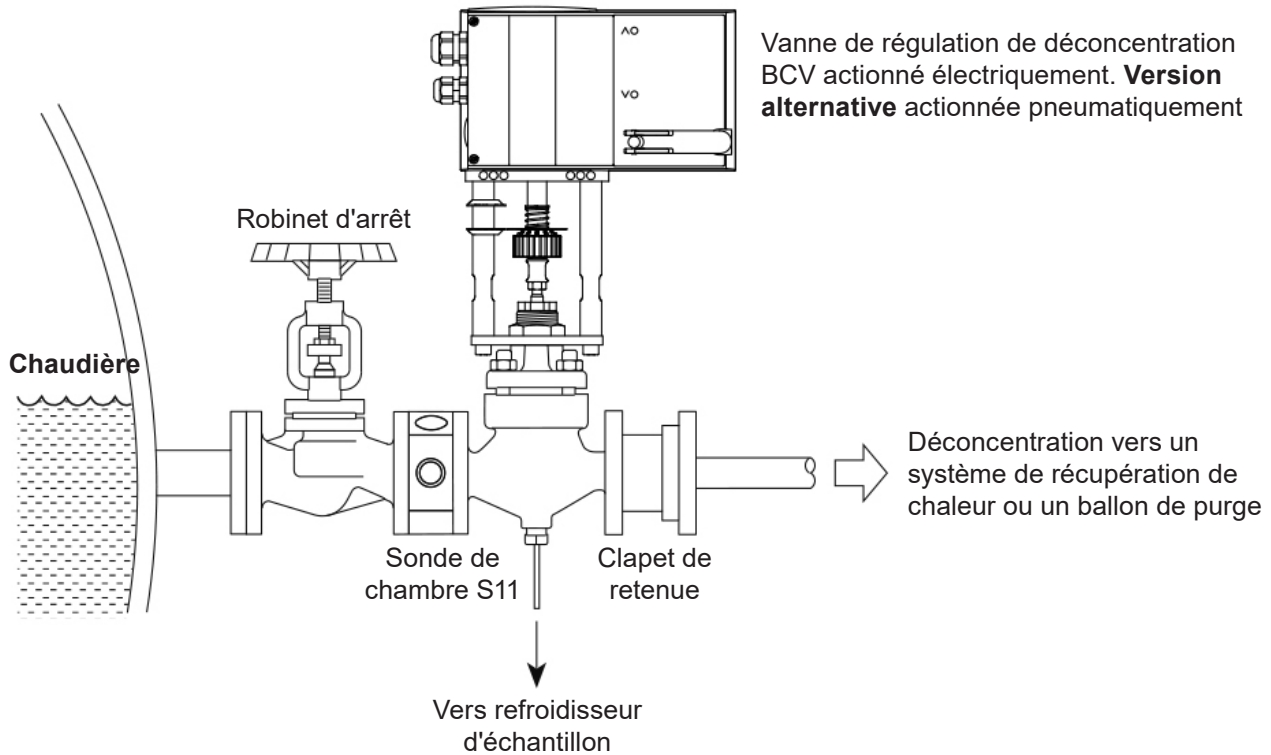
Installation sur un raccordement latéral de la chaudière
